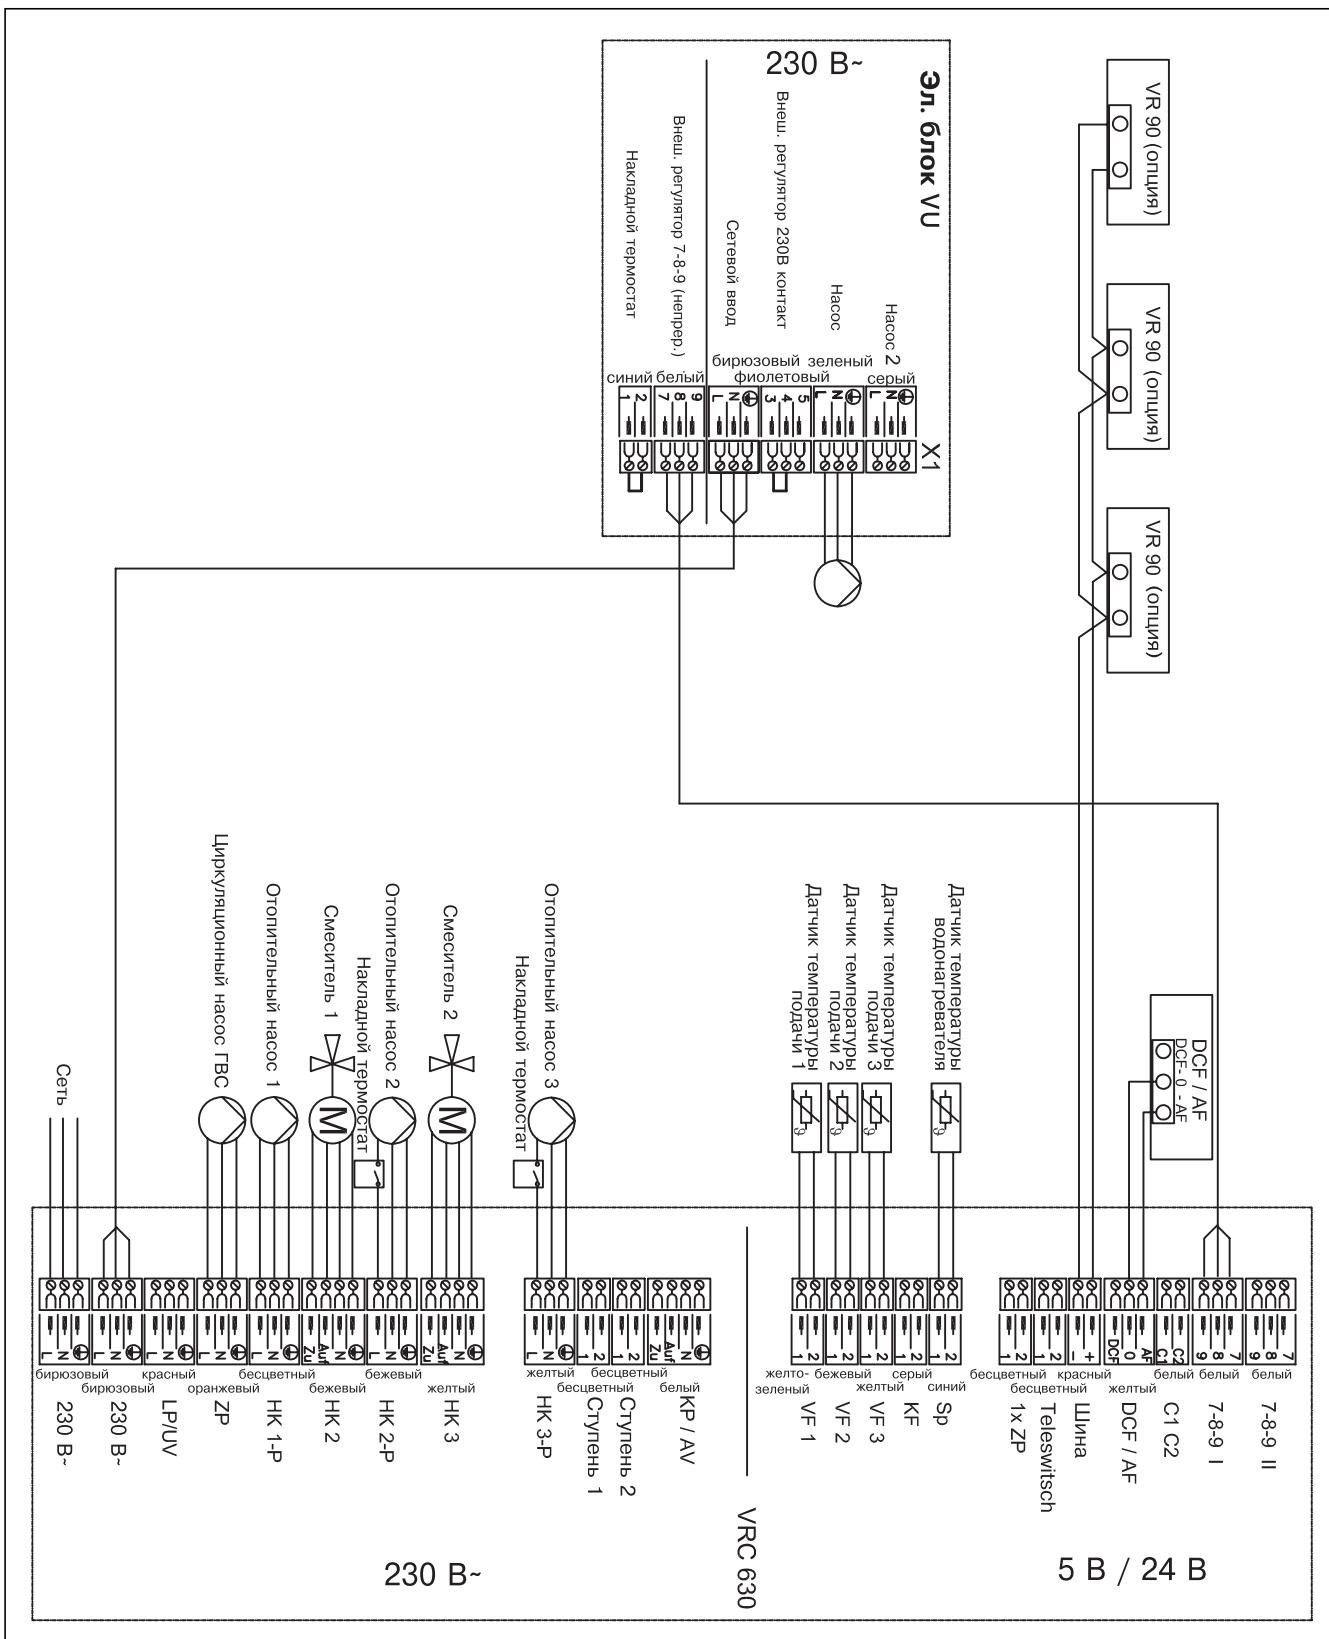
Соединительная электропроводка VRC 630, 1...VC, 3 ОК, VIH
